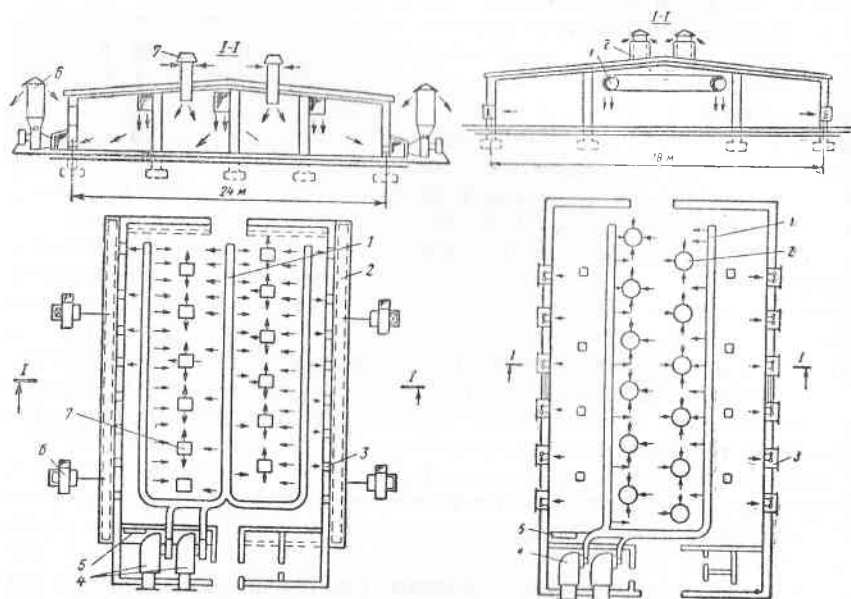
Схема вентиляции птичника «сверху — вниз», разработанная Гипроинсельхозом, ВНИИП:
